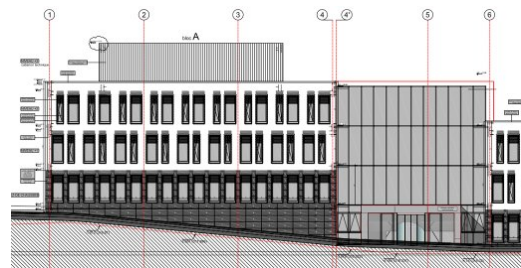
Fassadenansicht eines Gebäudeblocks A
